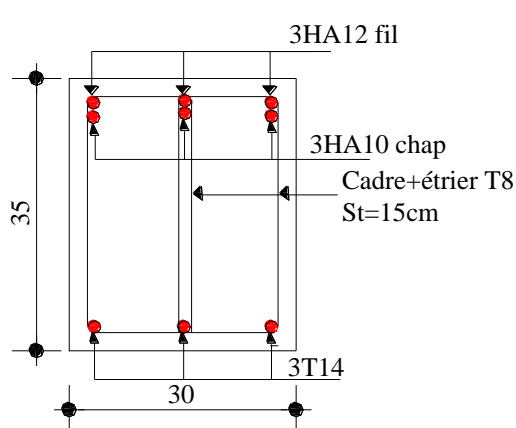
Schéma de ferrailage en appui de la poutre palière.
